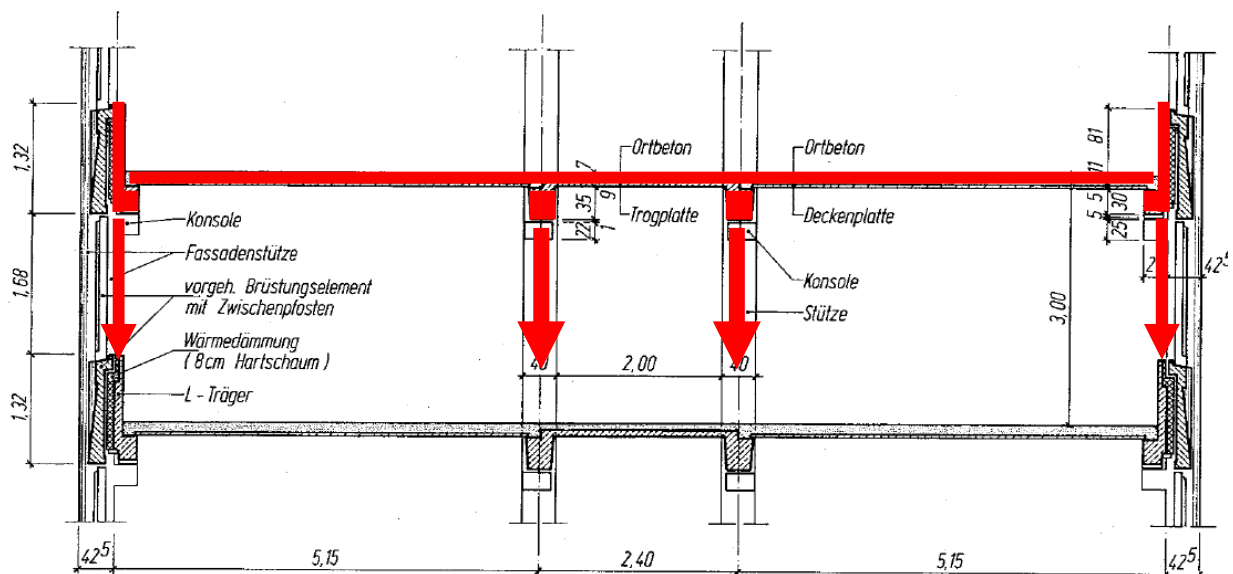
Tragsystem Bürogeschosse<sup>1</sup>
